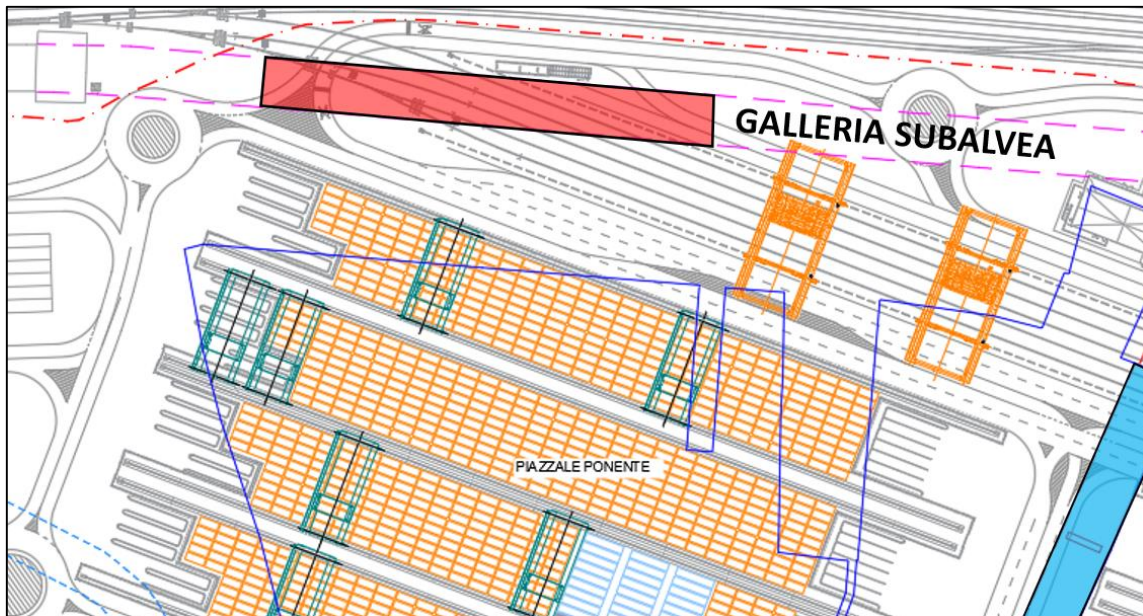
Intervento di rinforzo della galleria subalvea. Pianta
